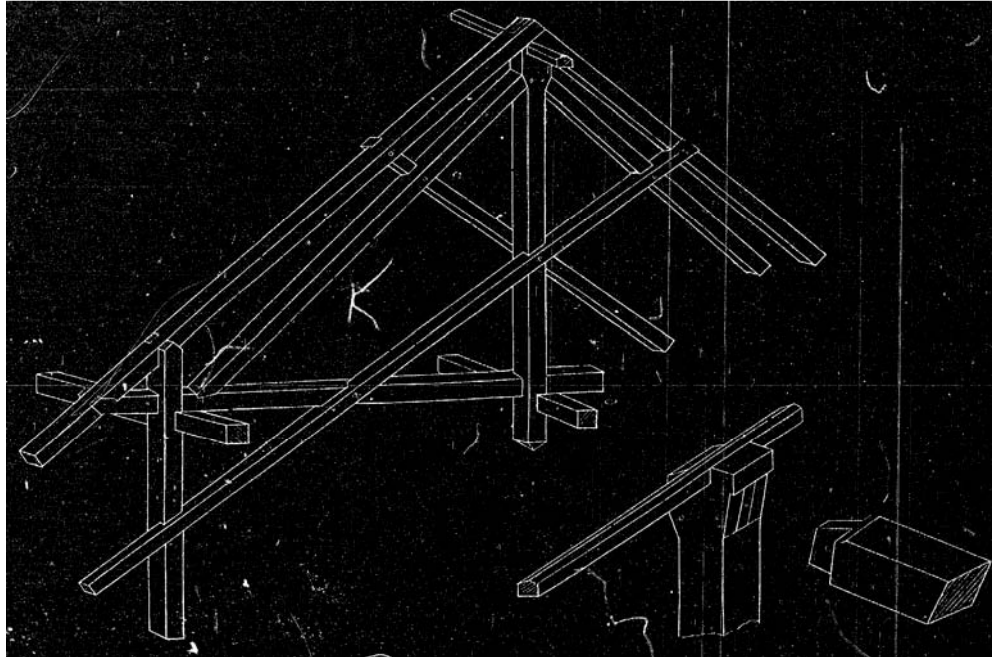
Detalhe do madeiramento de uma tipologia de tesoura.
